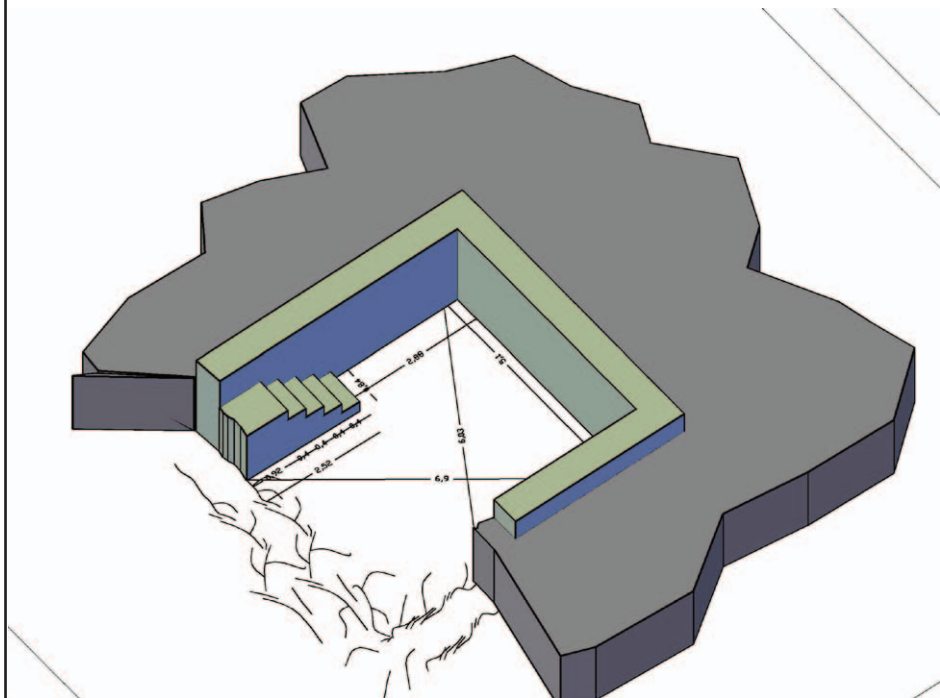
مسقط أفقي للصور الشرقي والمباني الملتصقة به (رسم الباحث)
